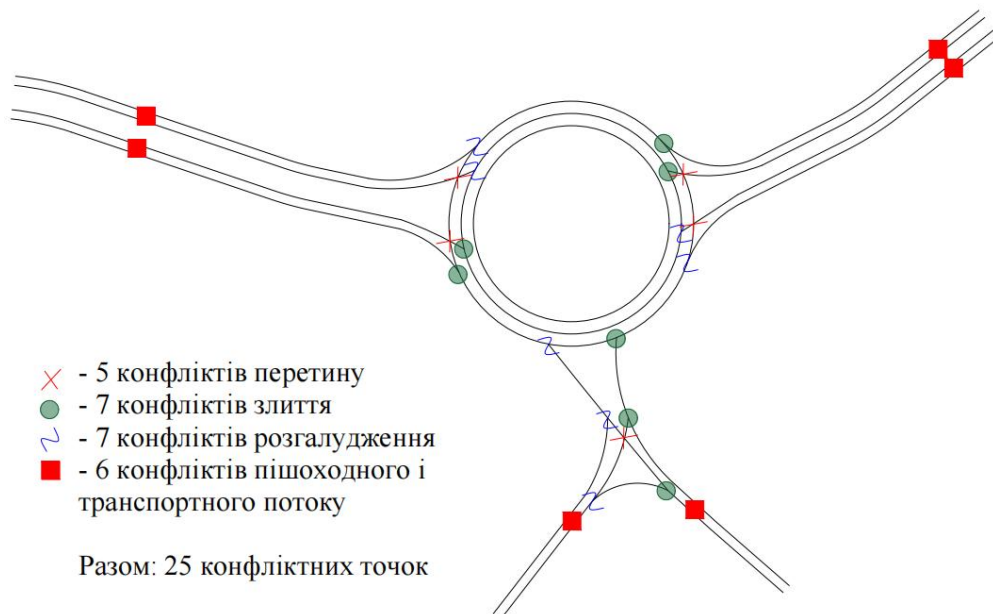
Схема конфліктних точок для планувального рішення №2.
